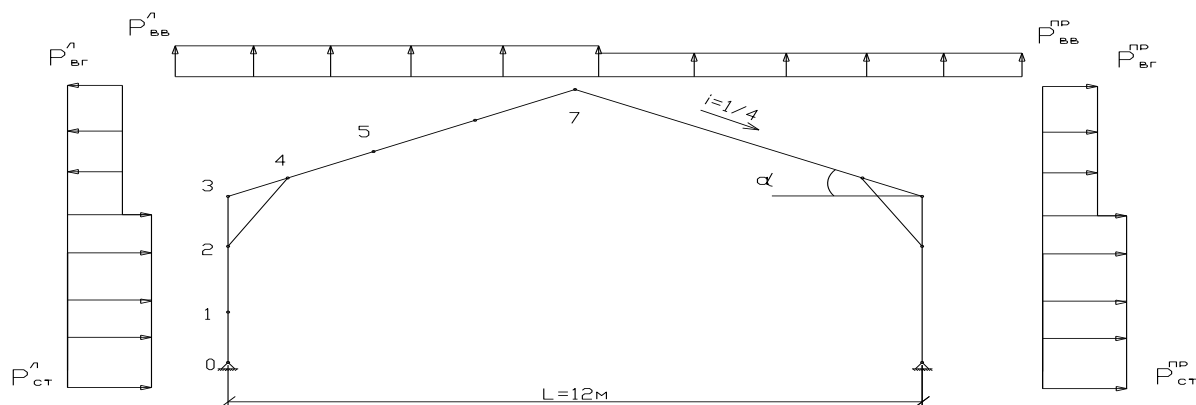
Расчетная схема рамы с характерными точками, для расчета ветровой нагрузки
